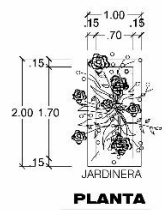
Plano de Detalles Constructivos (Techo verde, Jardinera) - Elaboración propia
